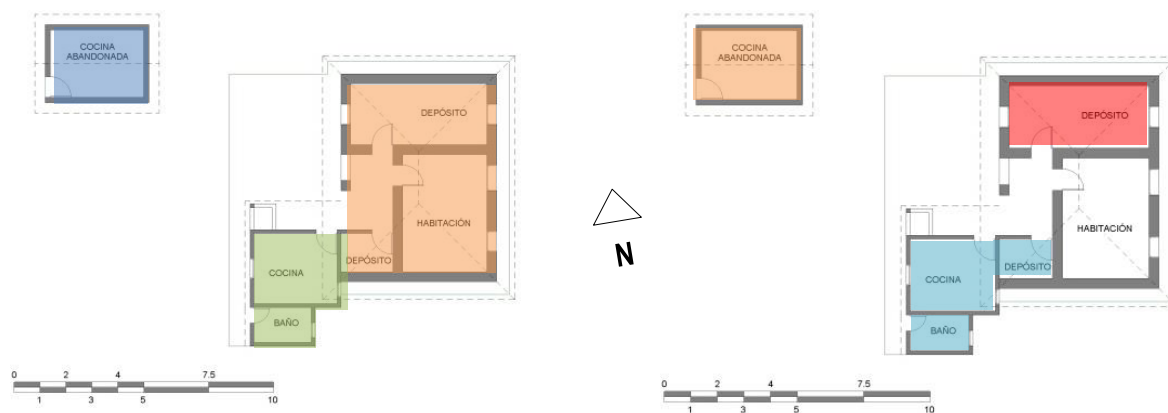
Vivienda en el municipio de Arcabuco. En la planta de la izquierda se aprecian las etapas de construcción de esta (naranja=etapa 1; azul=etapa 2; verde=etapa 3), mientras que en la planta de la derecha se pueden ver los cambios de uso a lo largo del tiempo (blanco=sin cambio; rojo=cambio; naranja=abandonado)
